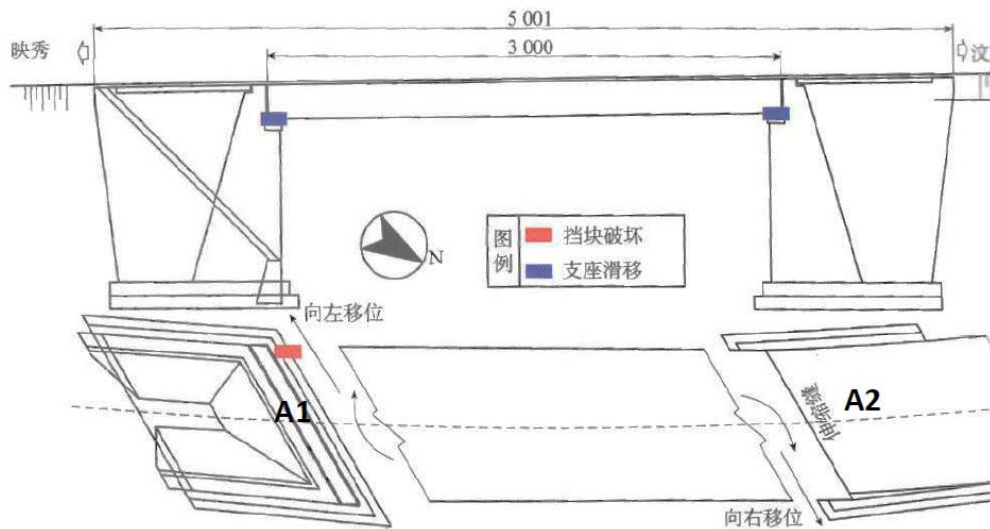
Elevación y Planta del Puente Louquanwan. Fuente: [14].
